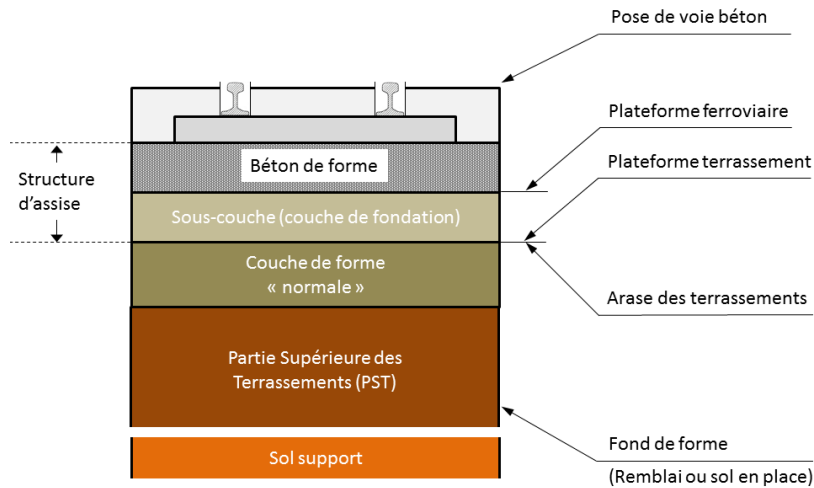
Structure type de voie ferrée non-ballastée (structure rigide) avec couche de forme normale (Source : ARTELIA Ville & Transport)
